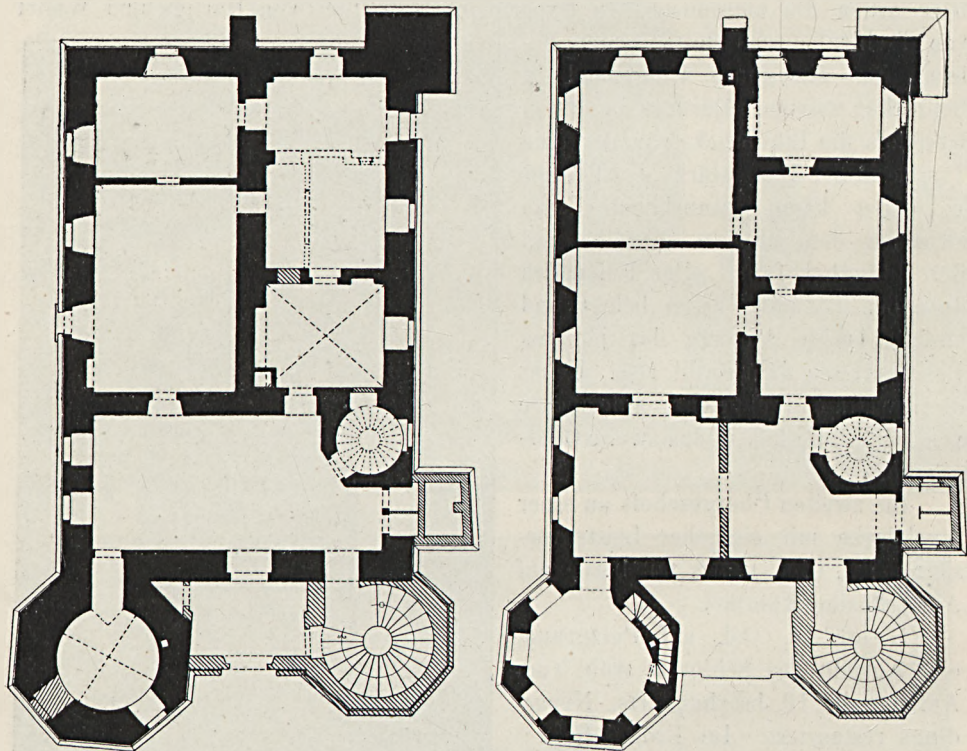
u. 5. Althörnitz, Schloß, Grundriß des Erd- und Obergeschosses.
